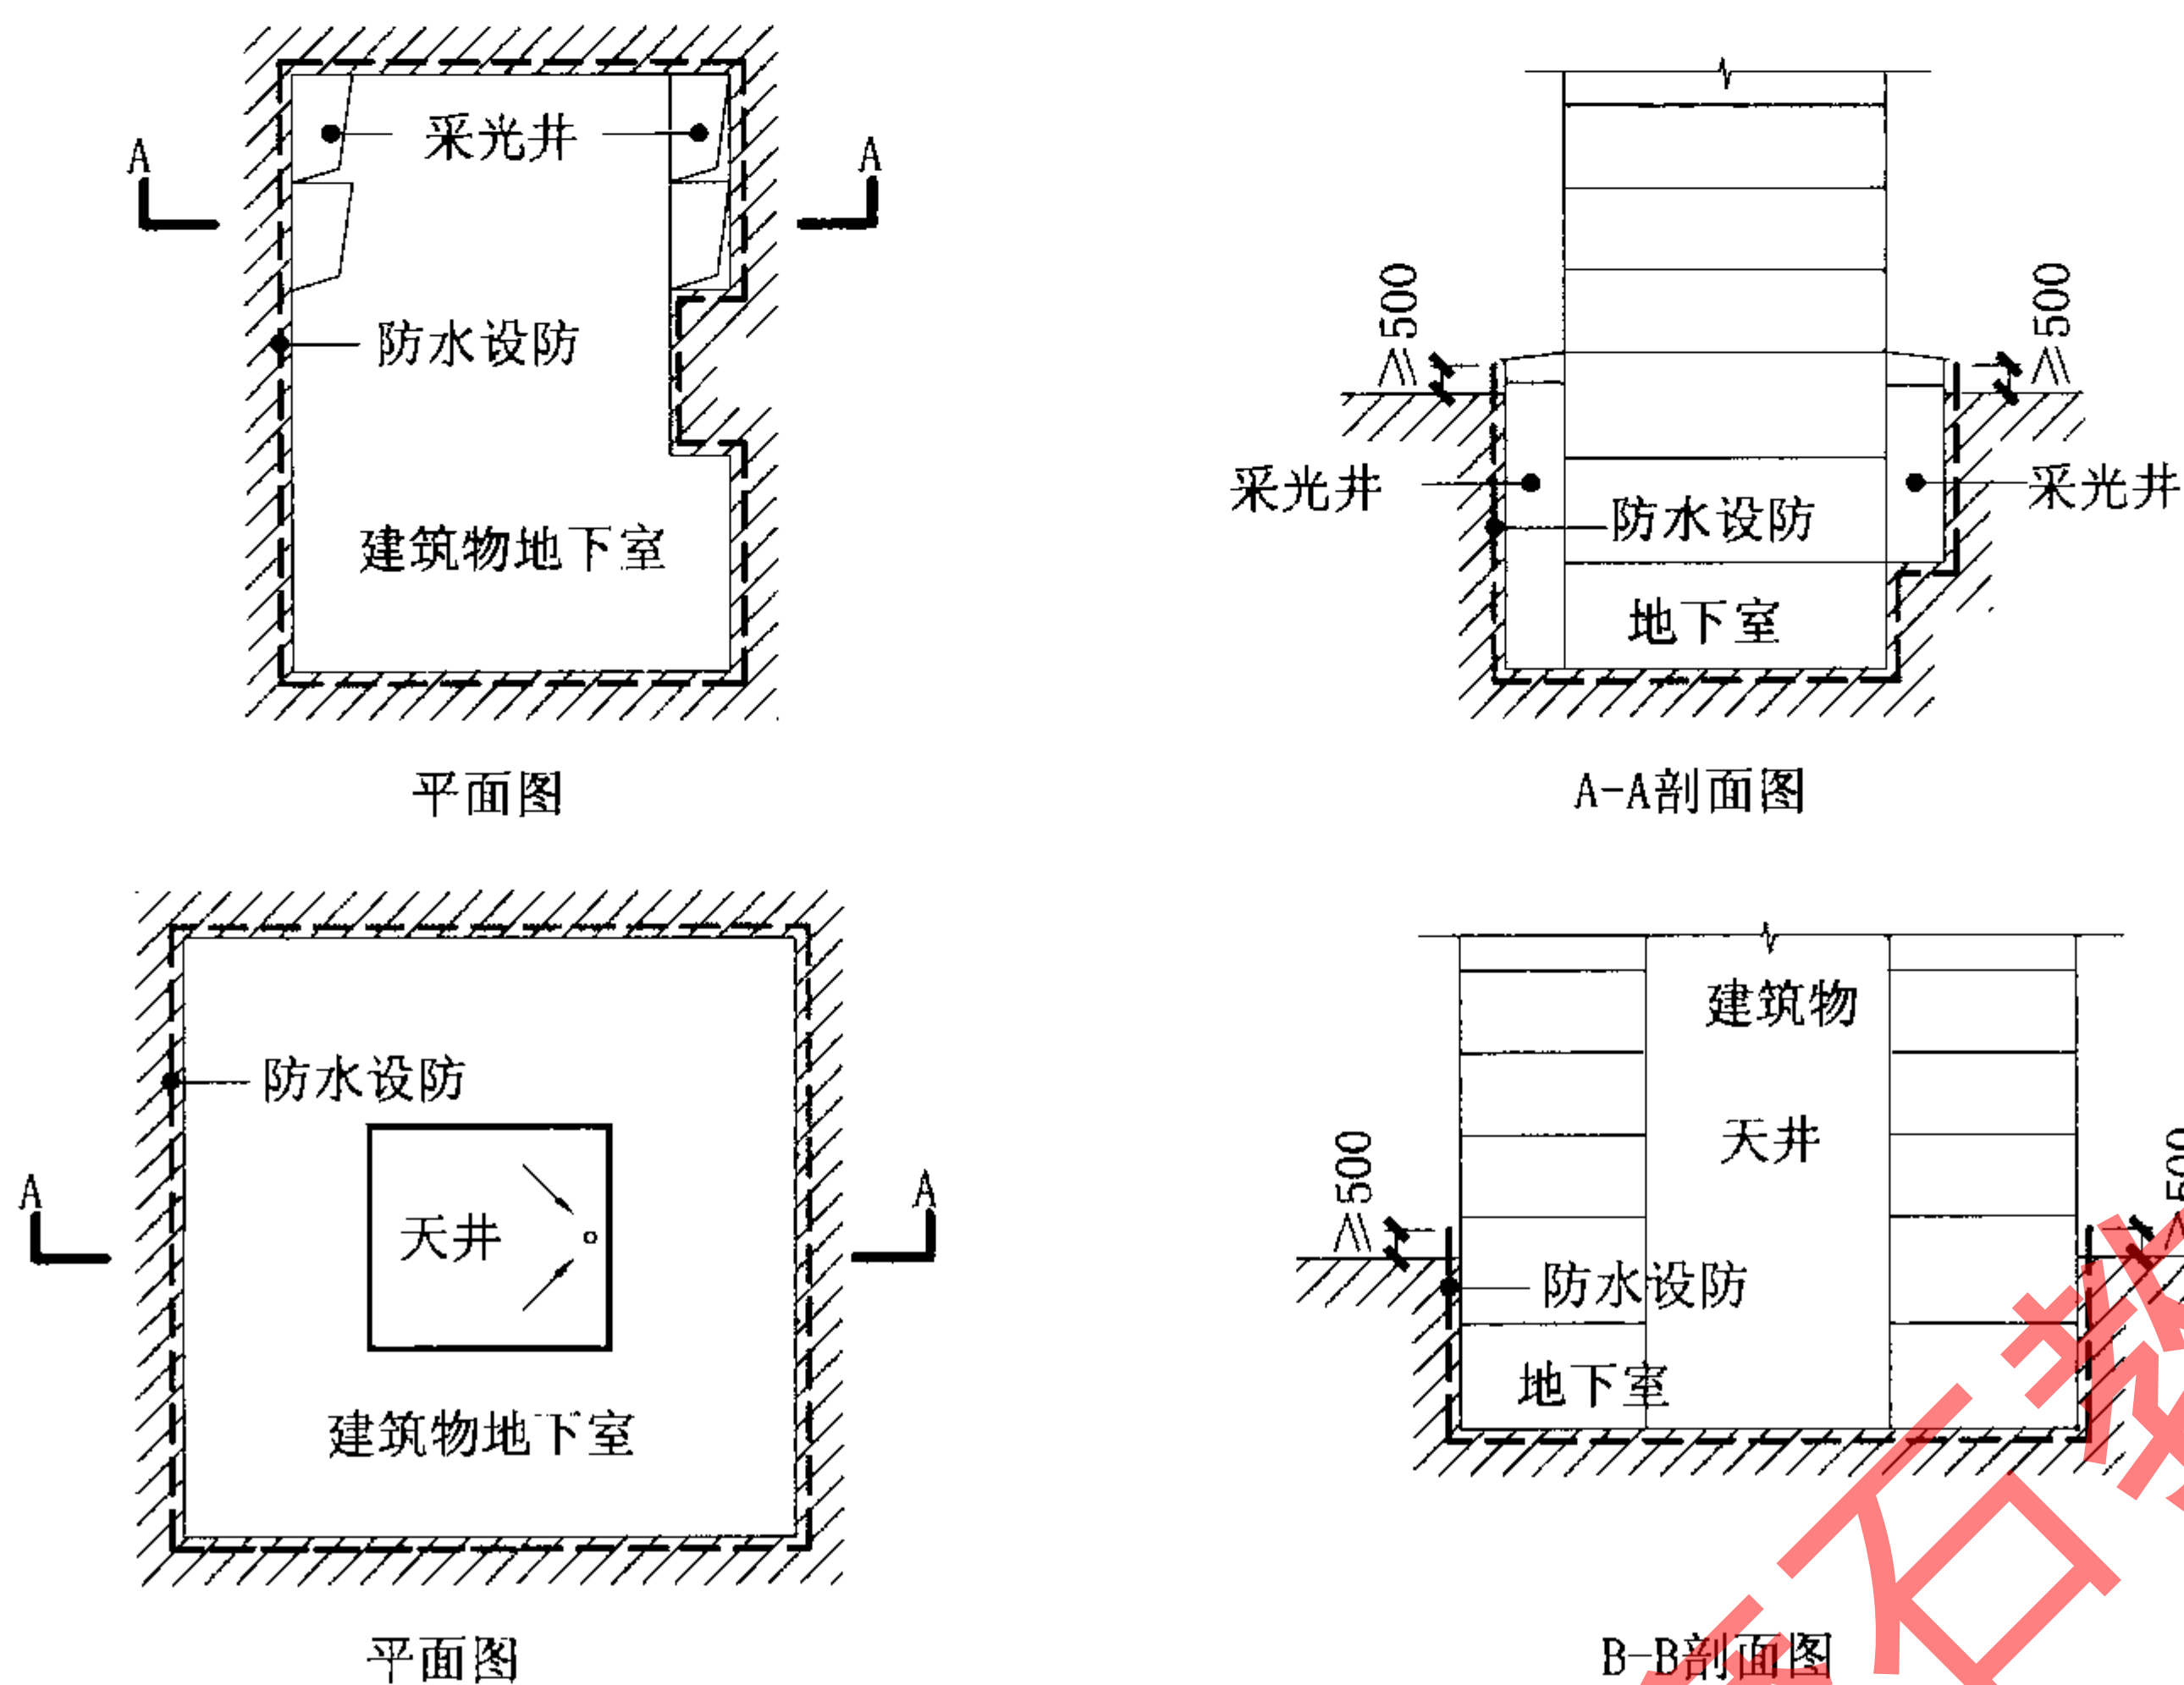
建筑物地下室防水设防示意二（mm）
